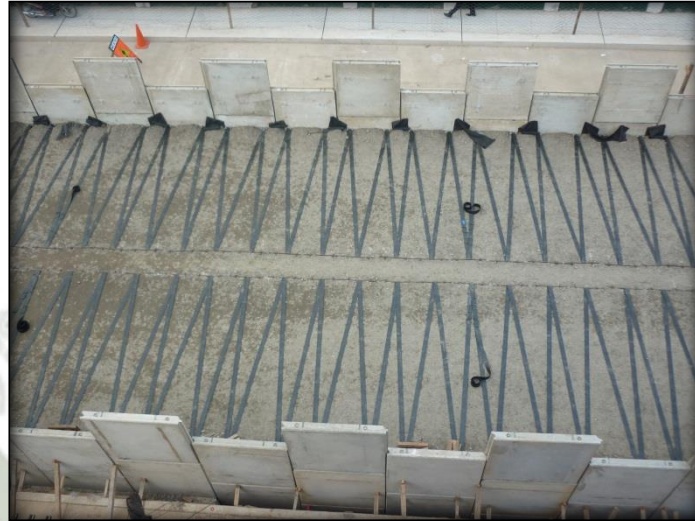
Distribución del refuerzo polimérico visto en planta
